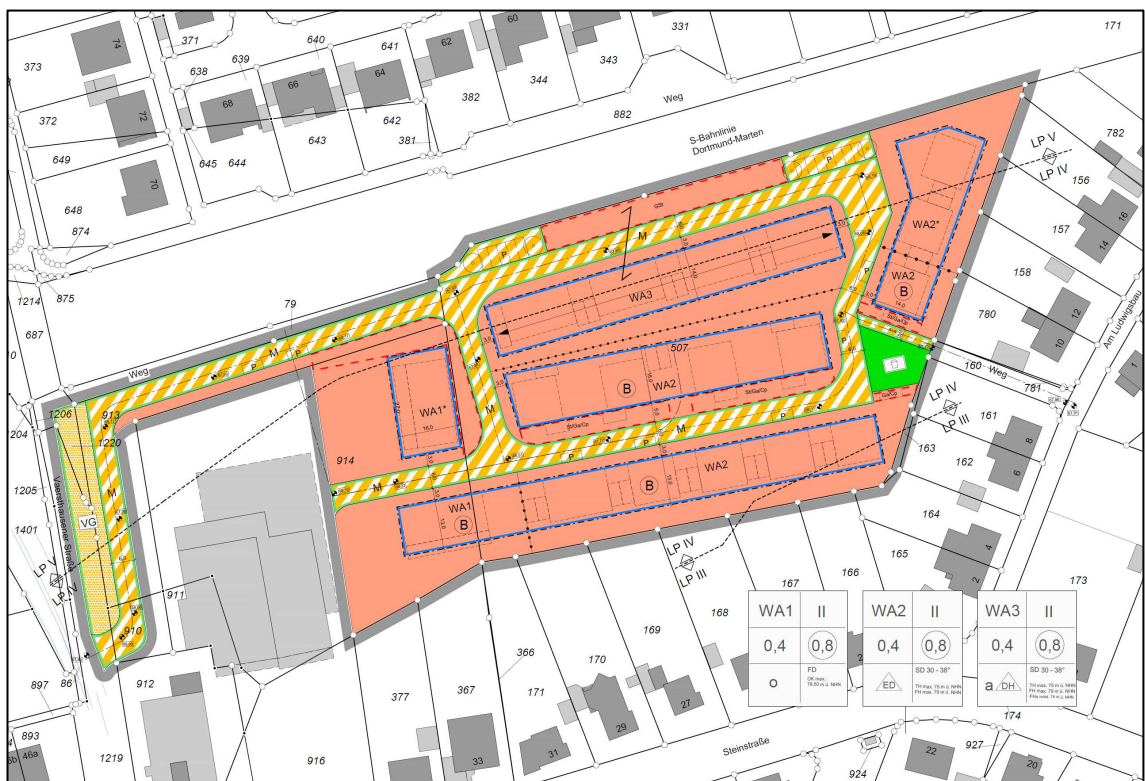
Bebauungsplan Unna Nr. 146 "Hof Drücke"
